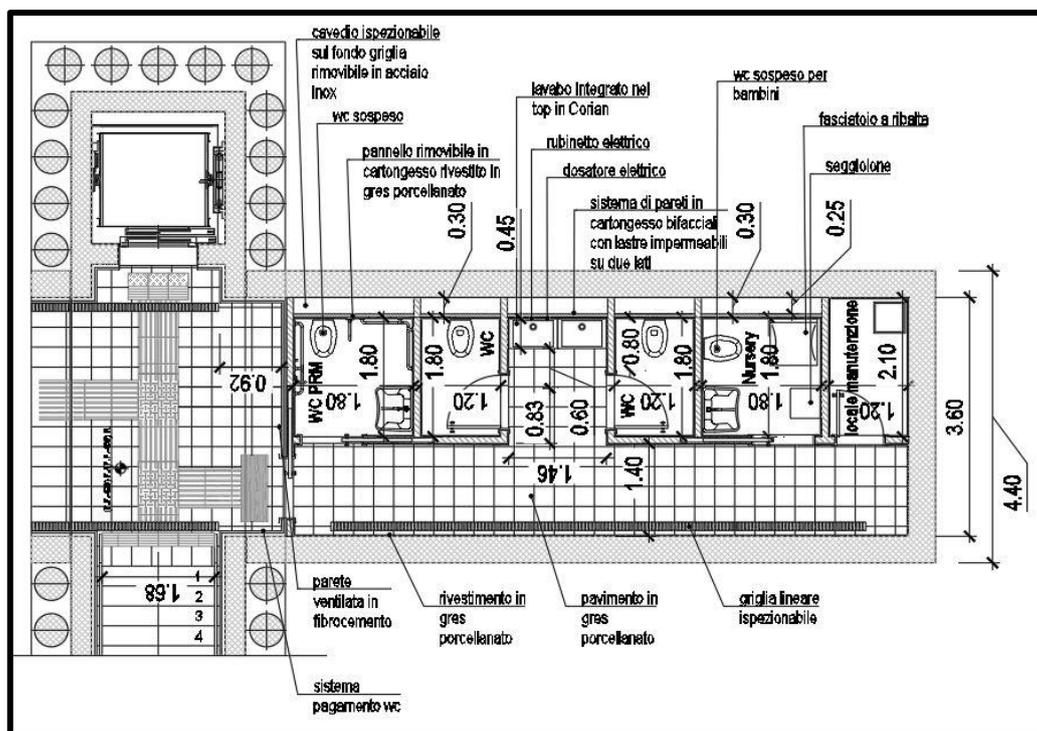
Stralcio Planimetria Locale Servizi Igienici
